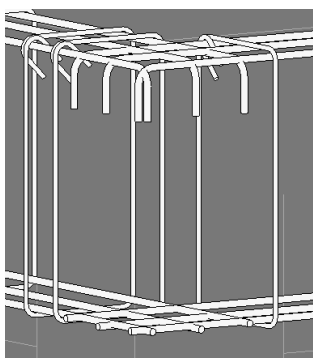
Encontro das armaduras das vigas V2-3 e V2-4.
